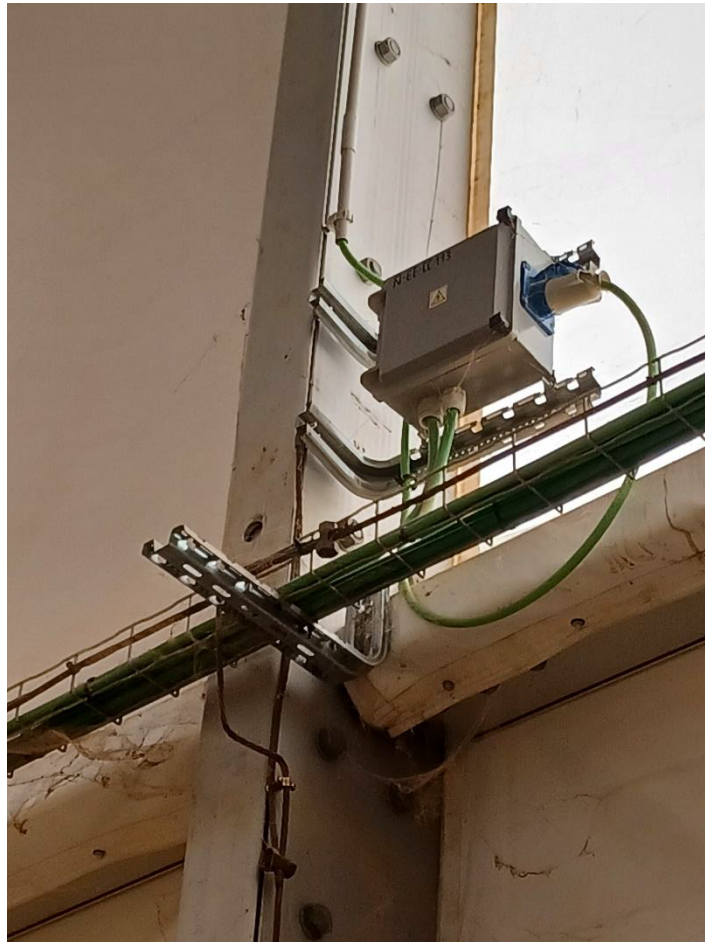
Detalle Caja de conexiones del alumbrado descolgado instalada en altura
